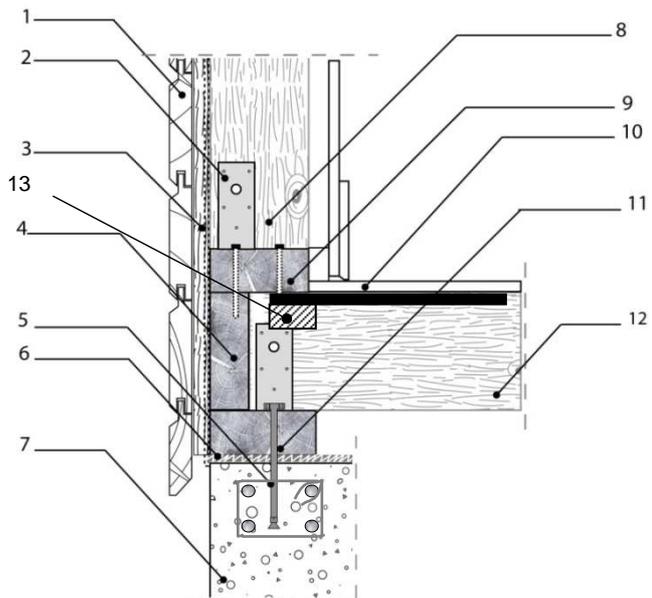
Coupe de principe Détail d'ancrage d'une lisse basse de mur extérieur sur plancher bois - panneau courant secondaire de mur de façade
